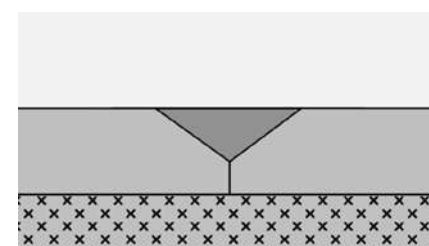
Большая площадь контакта сварочного шнура и покрытия. При этом прочность сваренного шнура примерно 140 N/CM.
